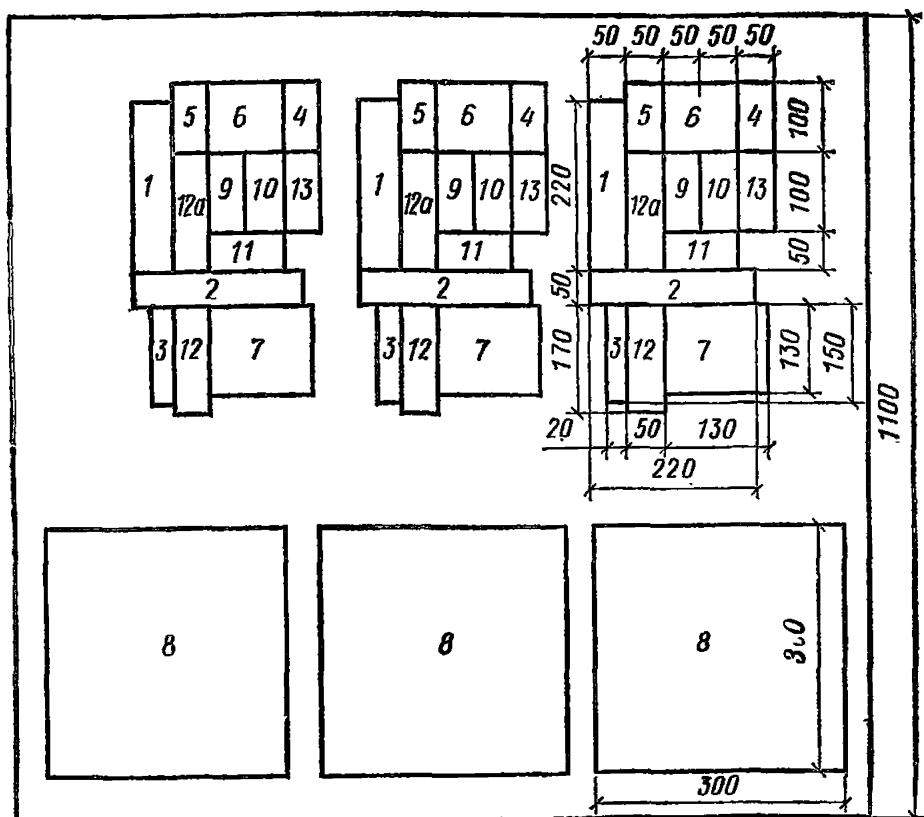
Схема вырубki из кровли шурфов на образцы для испытаний на водопоглощение (№ 6), водонепроницаемость (№ 7 и № 8) теплостойкость (№ 9) и гибкость (№ 3)
